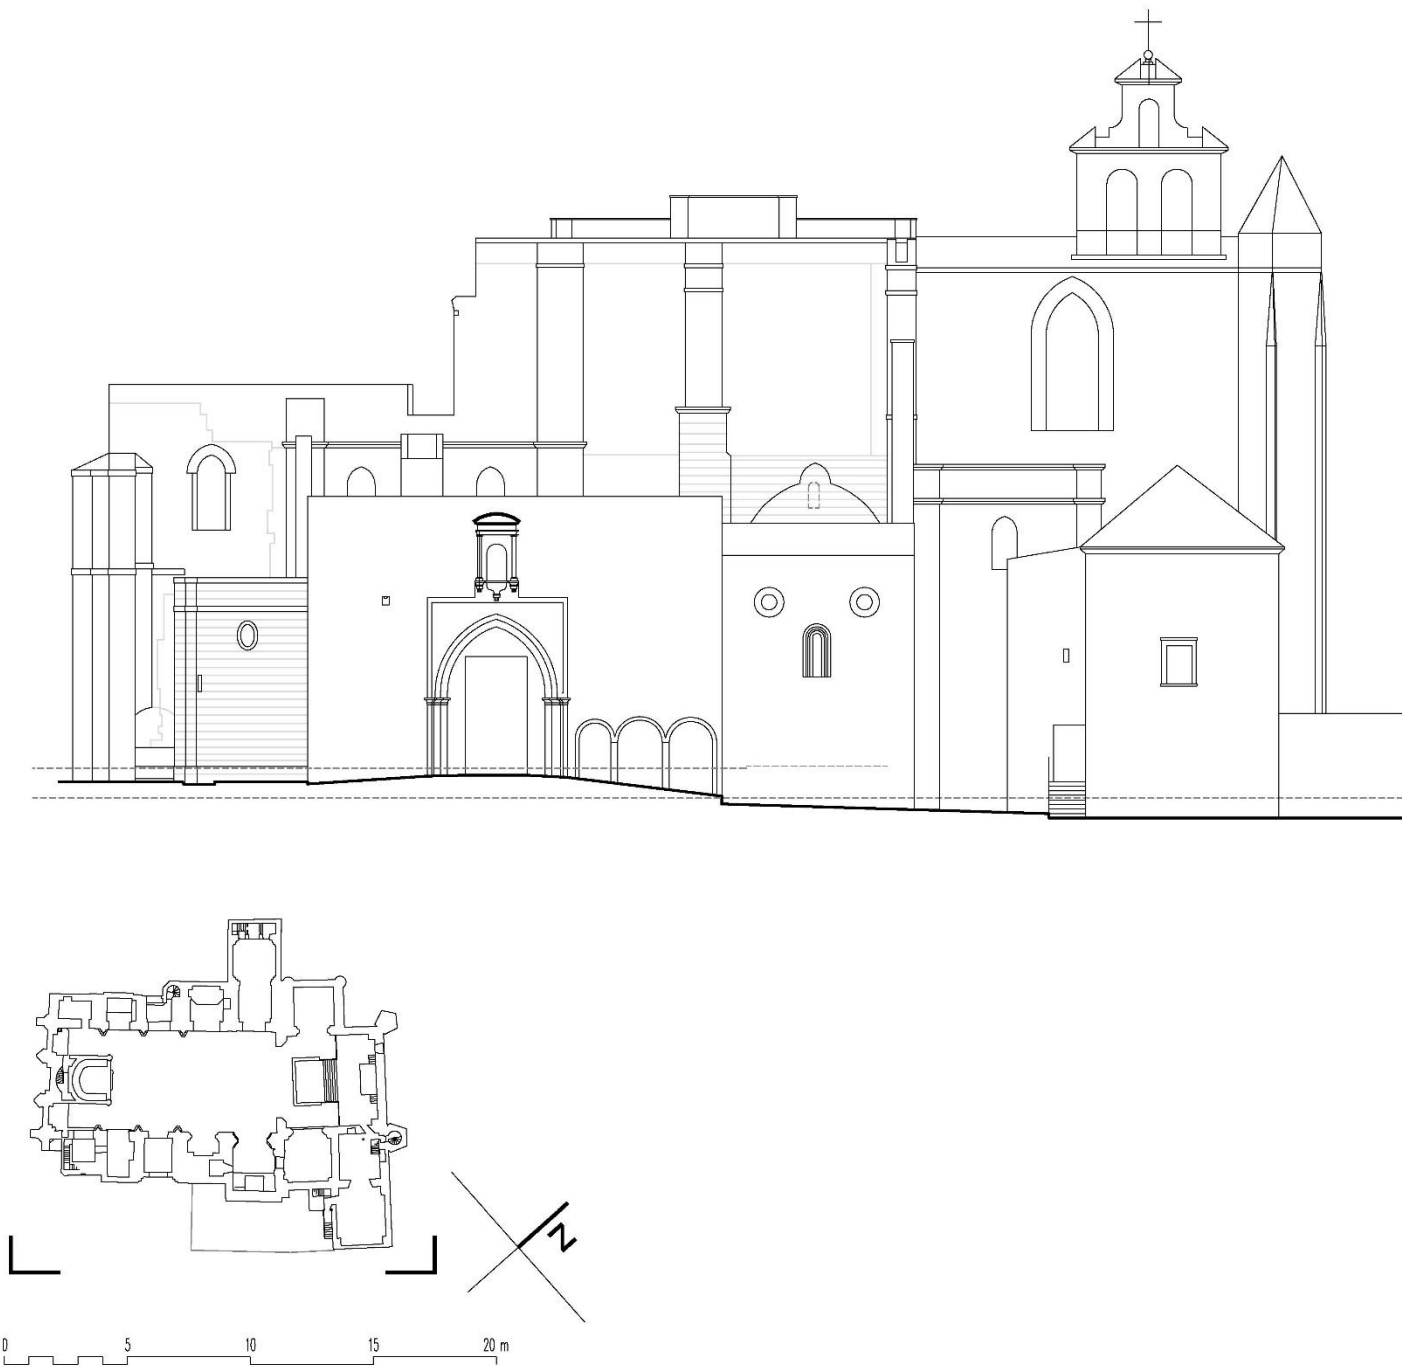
Alzado fachada sudeste. San Mateo. Jerez.
